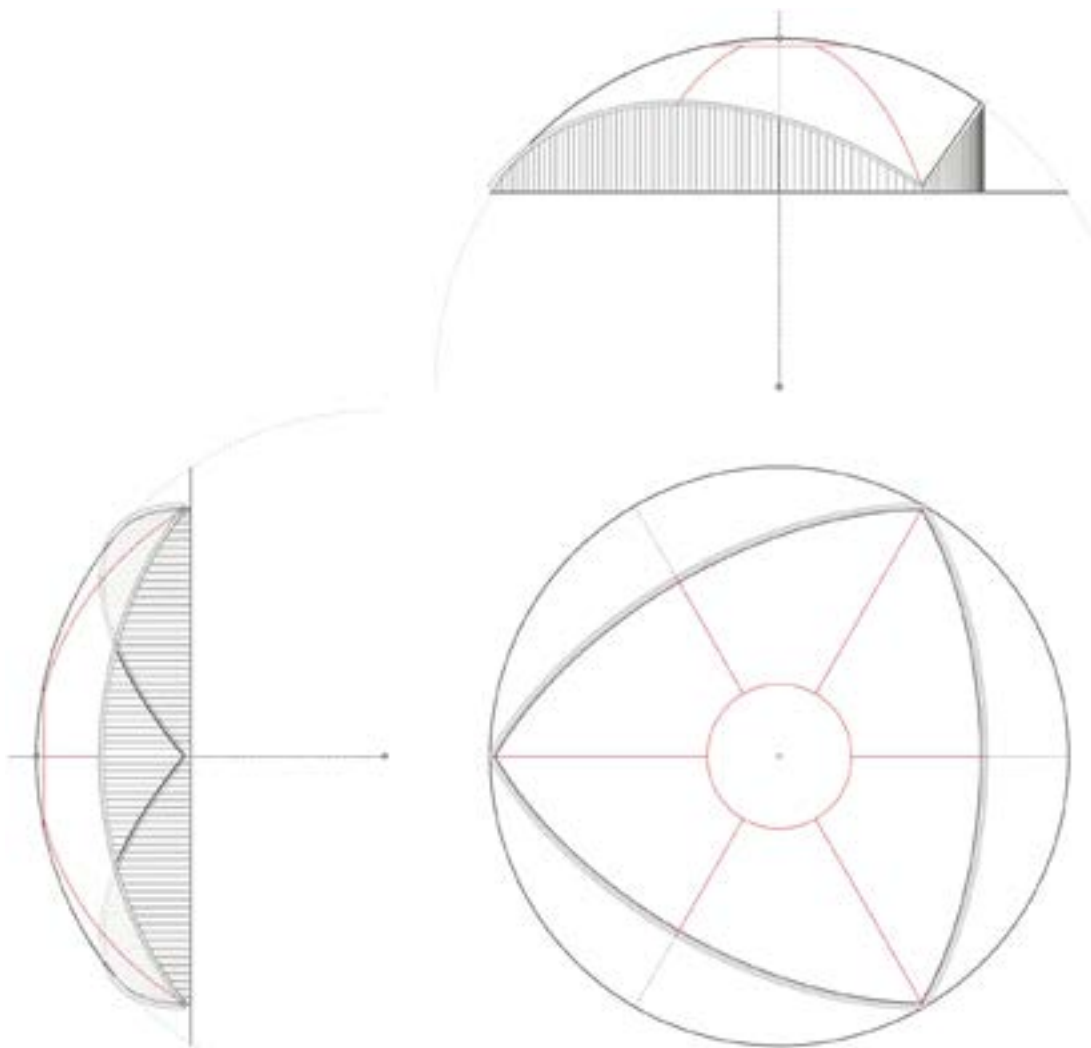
Esquema de planta y alzados del auditorio. Dibujo de los autores.
